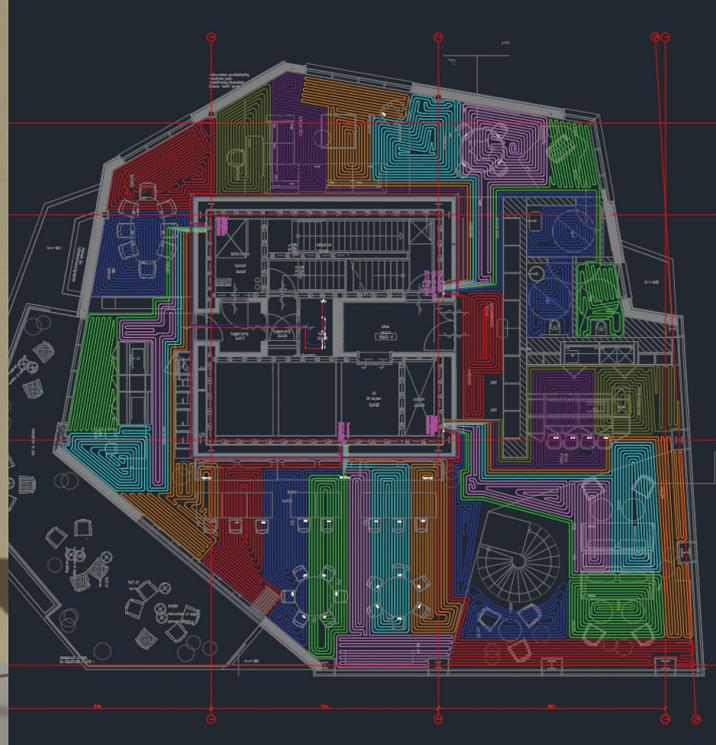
Ausgelegte und eingezeichnete Fußbodenheizung im Grundriss des 26. Stockwerks © JK Vloerverwarming
